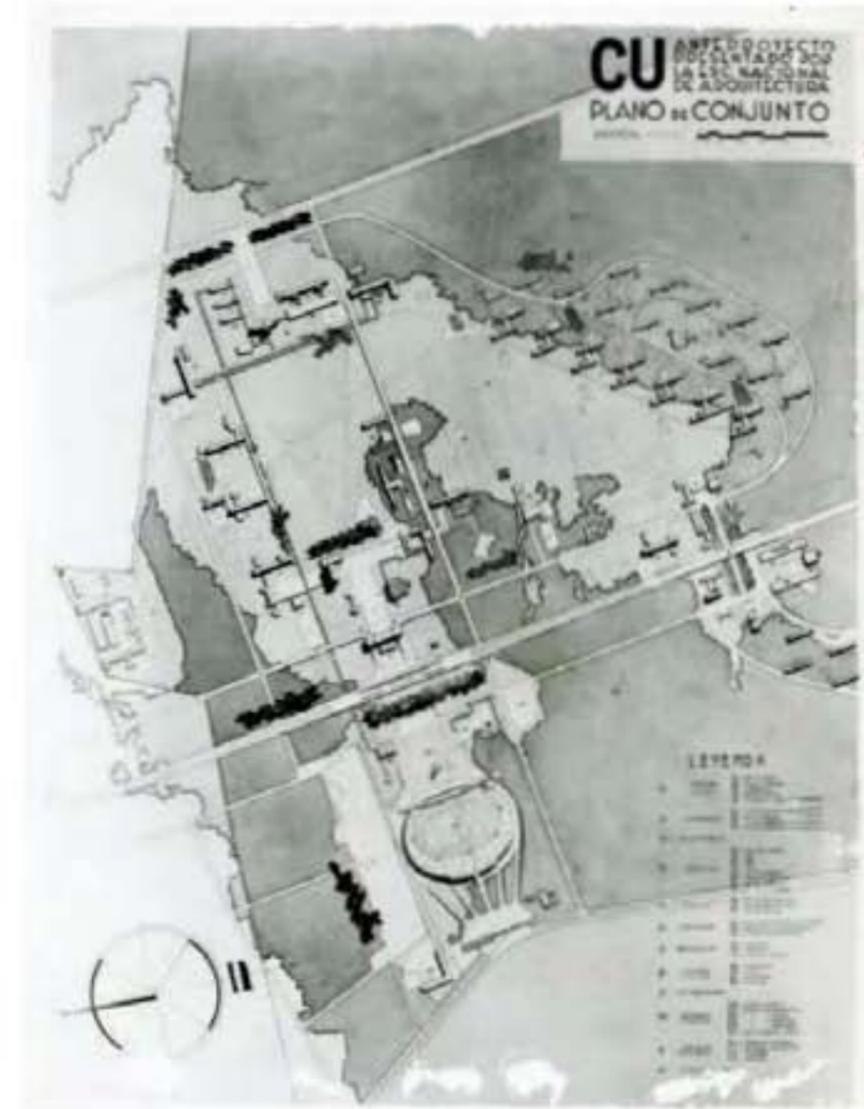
Plano 5. Propuesta de la ENA para el concurso nacional de CU: plano de conjunto, 1947. Obtenido de Drago Quaglia & Torre-Rojas, 2024
